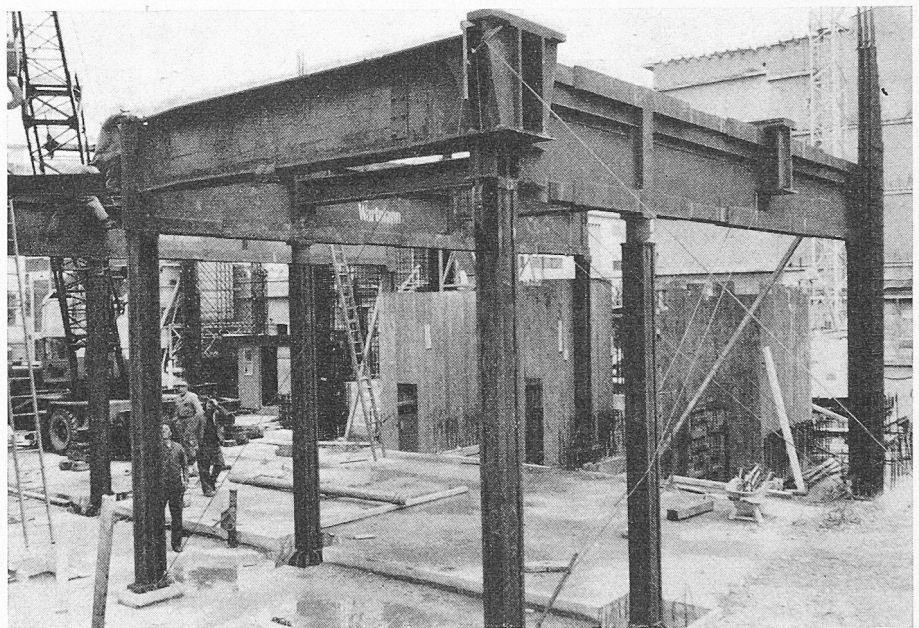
Teilaufnahme der montierten Stahlkonstruktion
